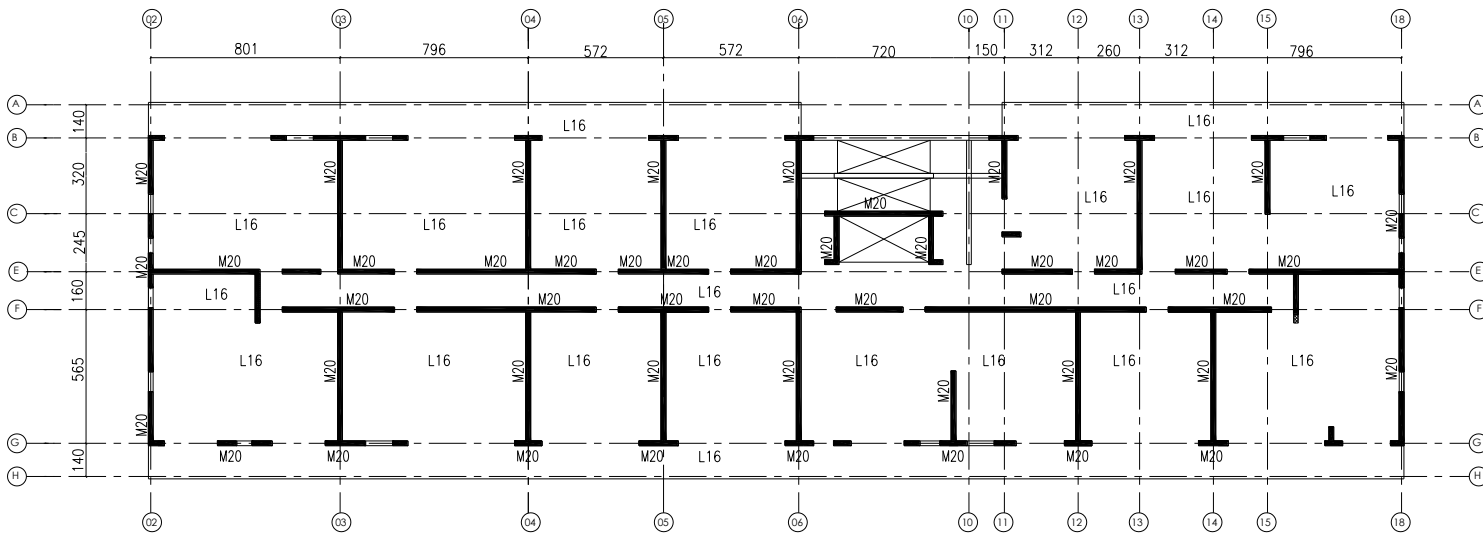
Planta de estructura de nivel tipo Edificio Torre del Sol (Revista AICE, 2012) [7].
